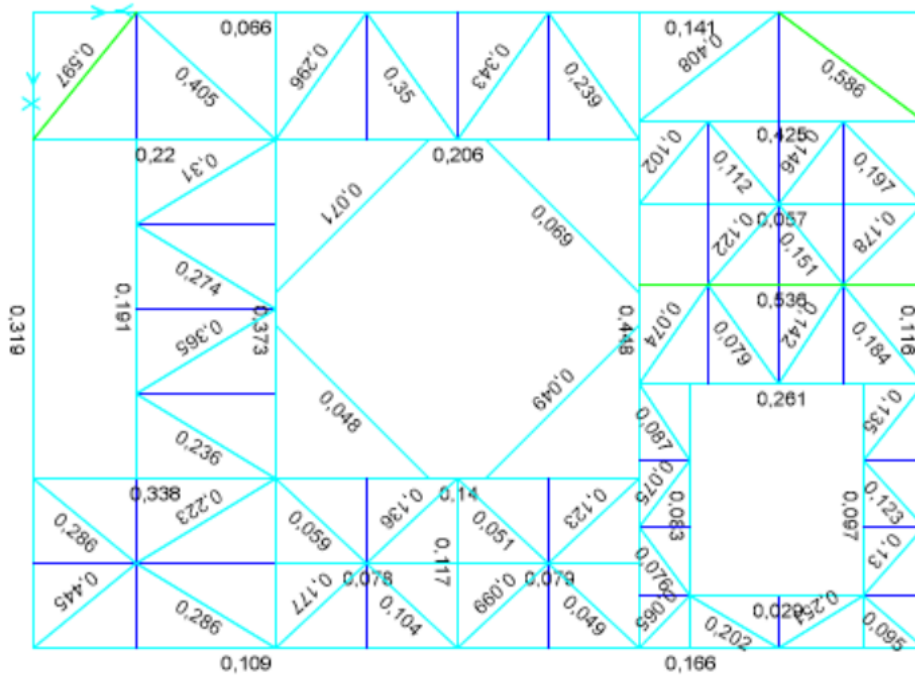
Factores de utilización vista en elevación 8.42 [m] sobre nivel de terreno.
